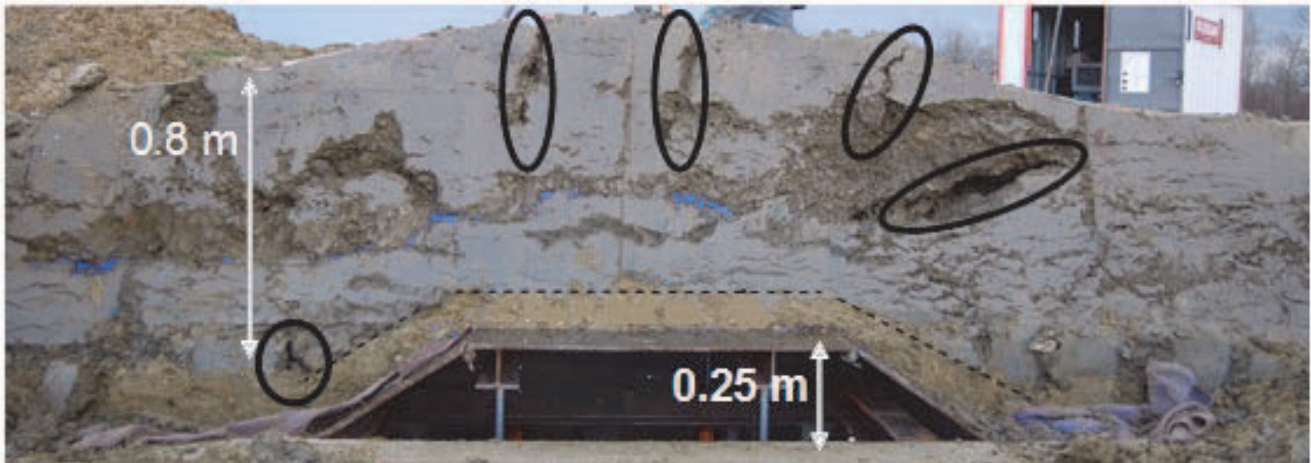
Coupe de la poutre d'argile déformée en fin d'essai avec une ellipse autour des zones fissurées (Camp et al., 2010)
